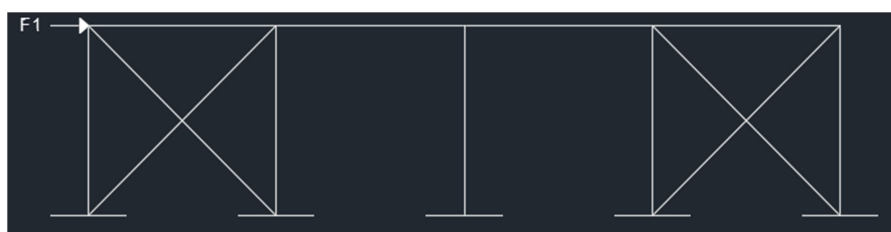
Esquematización de las cargas en los arriostramientos de la fachada OESTE
